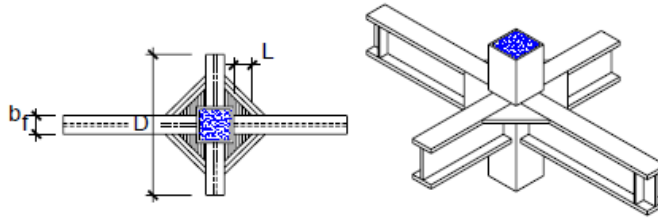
Ligação viga I-perfil tubular utilizando chapas enrijecedoras triangulares externas - Oh et al. (1995)
